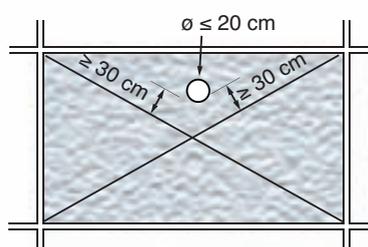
Perçement autorisé d'un mur de contreventement (Règles PS-MI 89/92)
